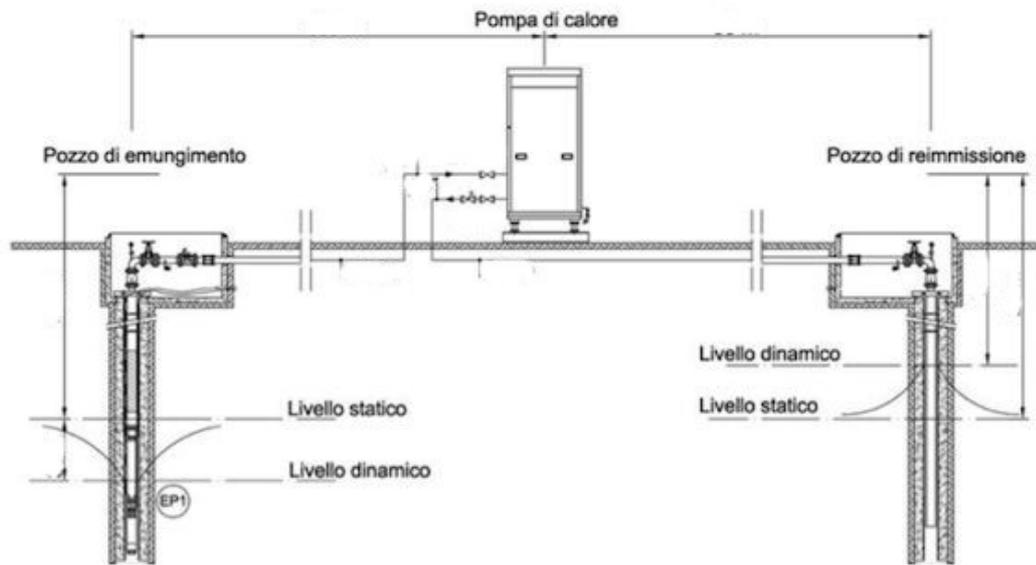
Schema tipico impianto geotermico ad acqua di falda con emungimento e reimmissione
